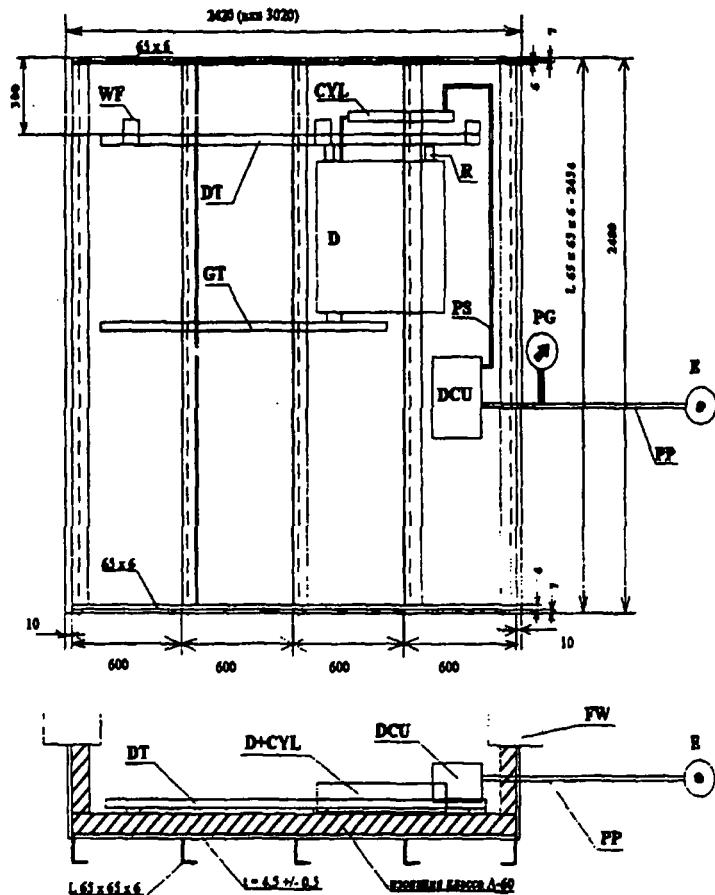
Основа конструкции для установки прототипа системы управления противопожарными дверьми.
